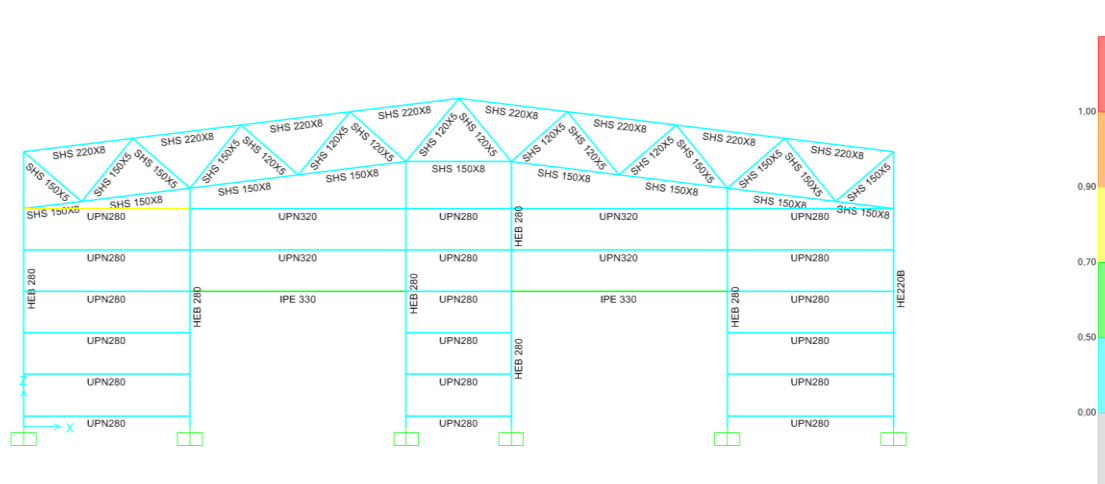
aprovechamientos pórtico fachada 2 ($y=84$)
